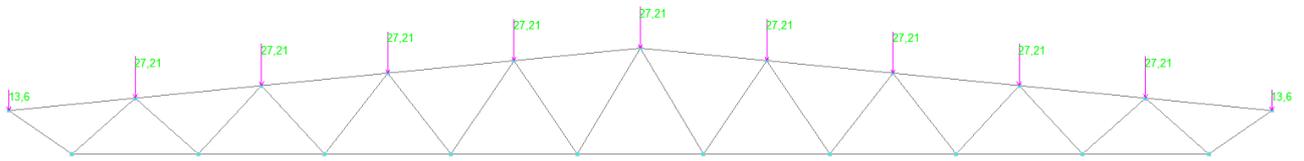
Нагрузки на стропильную ферму от временной нагрузки
